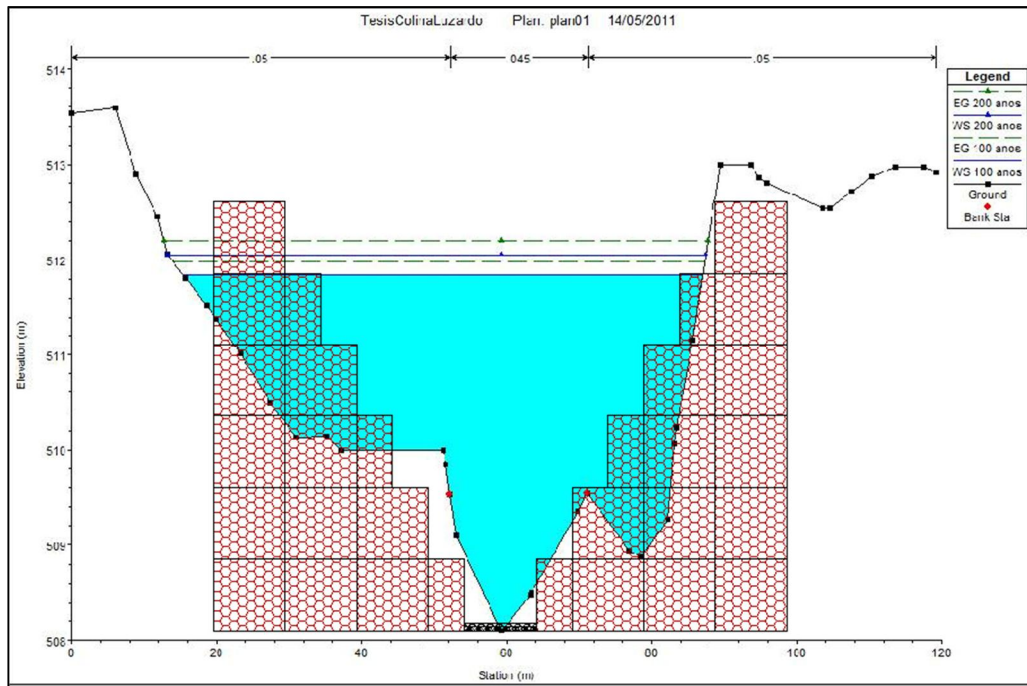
Detalle del muro de gaviones. Nota. Elaboración de los autores.
